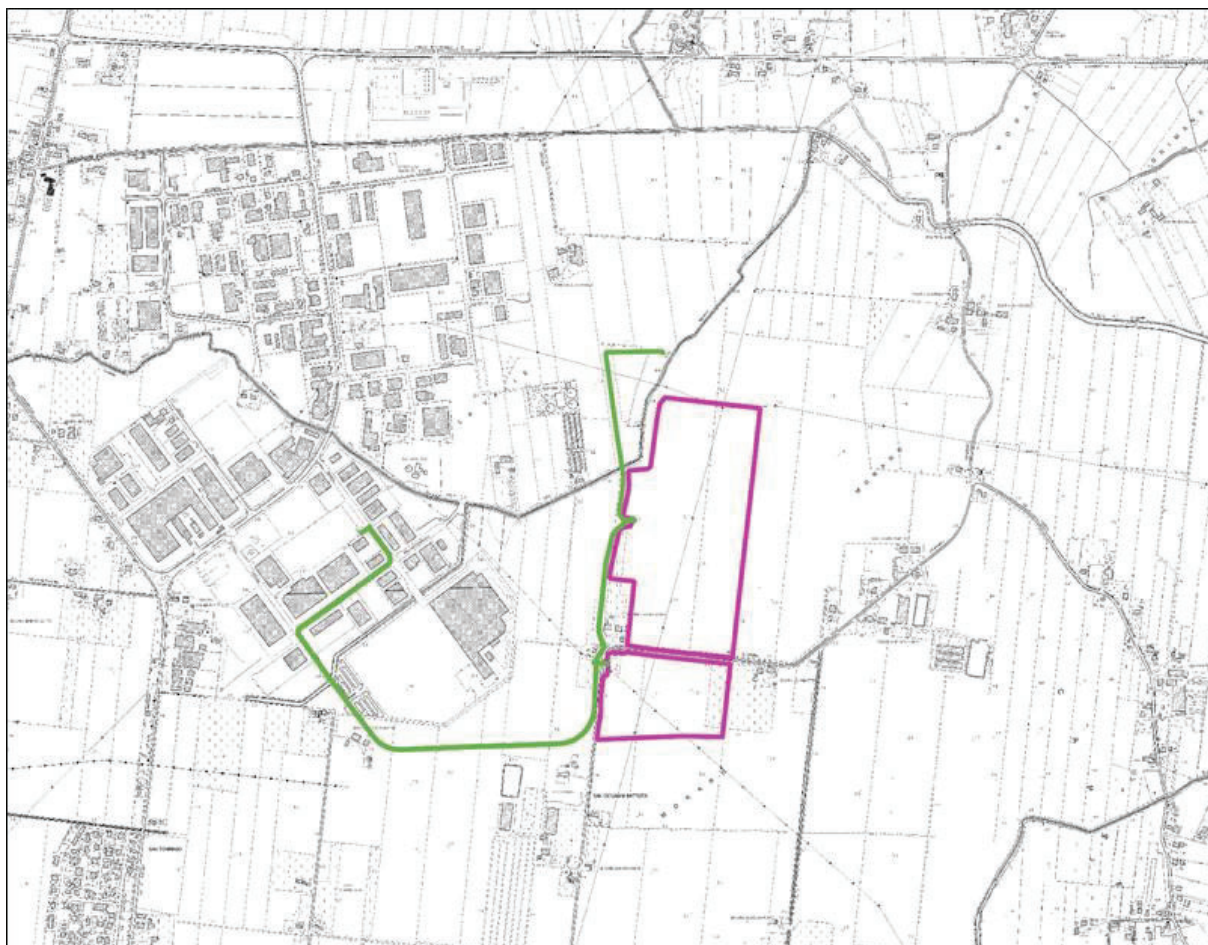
Planimetria generale dell'intervento su base CTR (sezioni 147160 e 168030)
